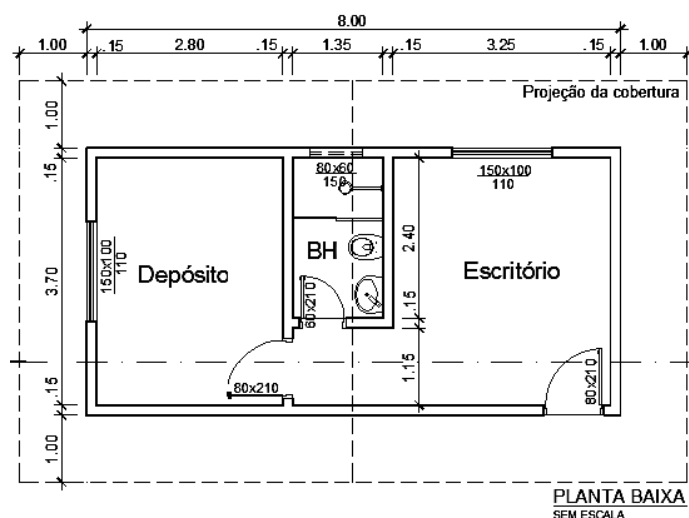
planta baixa da edificação, contendo projeção da cobertura representada por linhas tracejadas.
